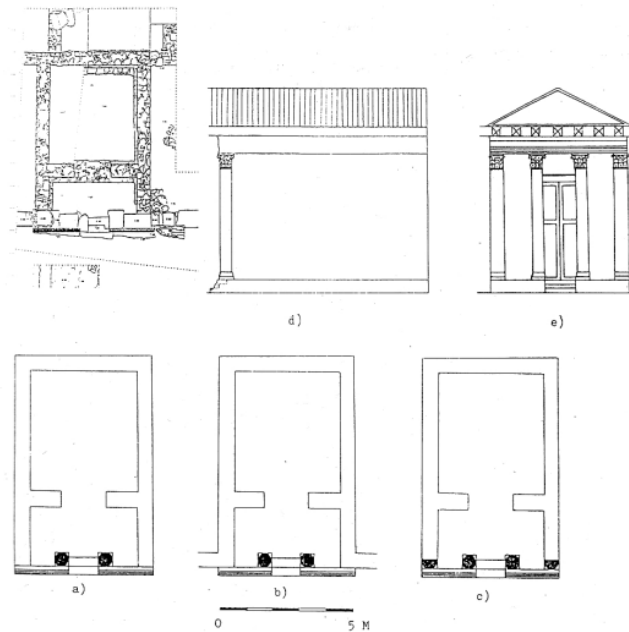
Planta de la excavación del *sacellum* de *Iliturgi* e hipótesis de reconstrucción.
